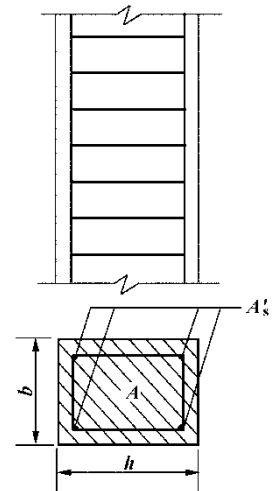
配有箍筋的钢筋混凝土轴心受压构件截面图
